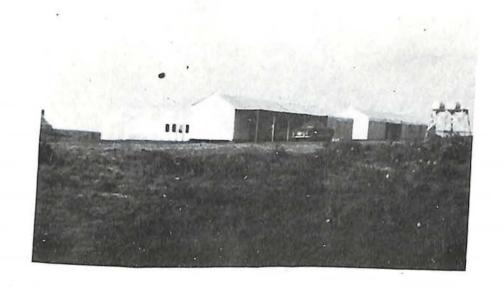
VISTA DEL CAMPAMENTO YA TERMINADO.
